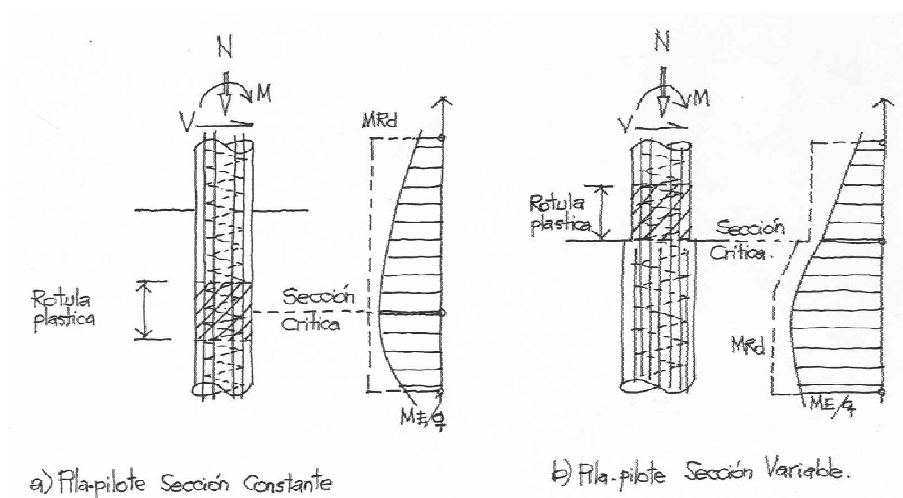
Pile pali. Variazione di rigidità per ottenere la formazione dell'articolazione plastica in una zona accessibile per gli interventi di ispezione e riparazione [1]
